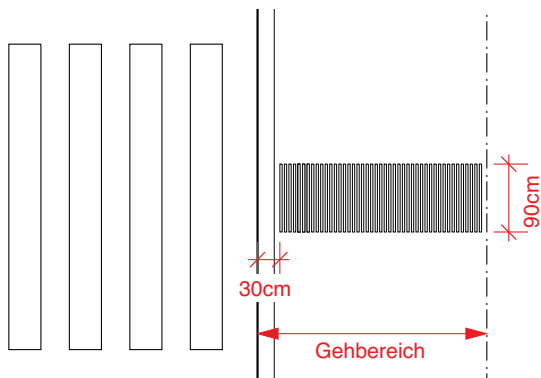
Leitlinie zur Treppe unten, alle Stufen markiert
